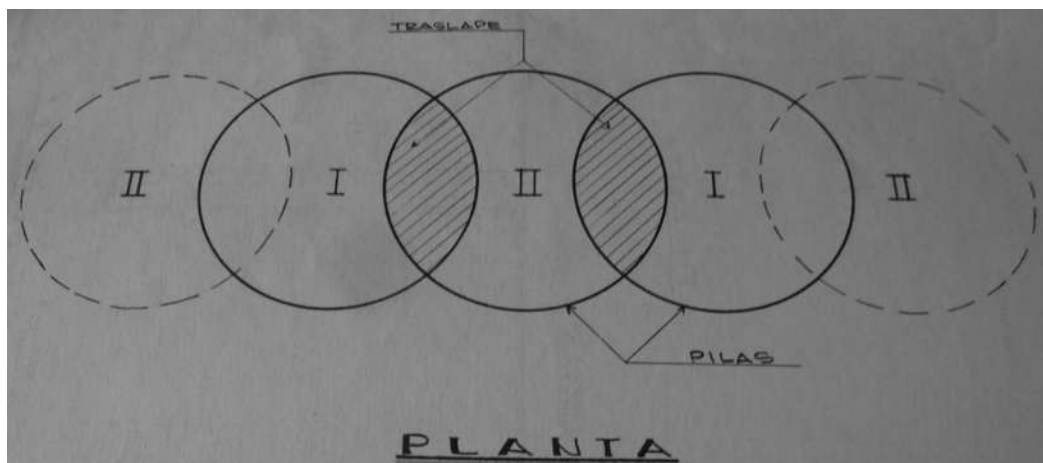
Tunnelling falso con estructuras de contención a base de pilas secantes.
